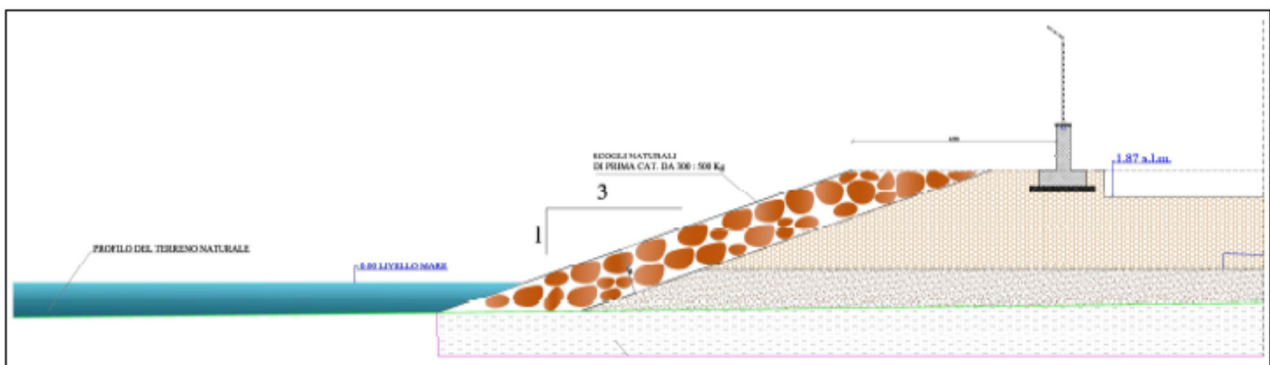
Sezione B-B -Esecuzione piazzale rilevato, scogliera e recinzione
